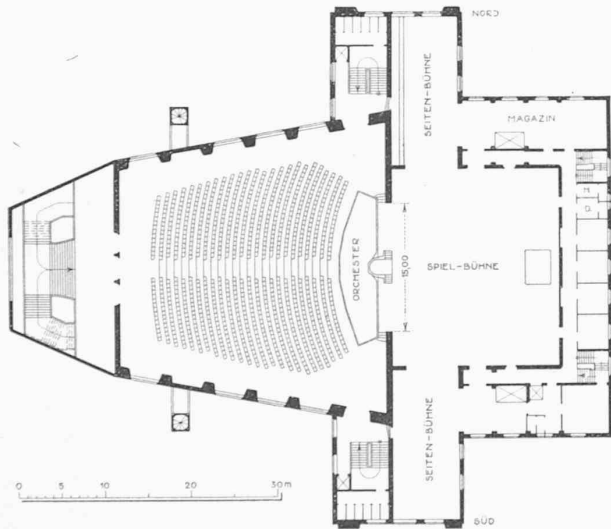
Saalgeschoss-Grundriss (Gebäudelänge 70 m, Breite 60 m). — 1:800.
